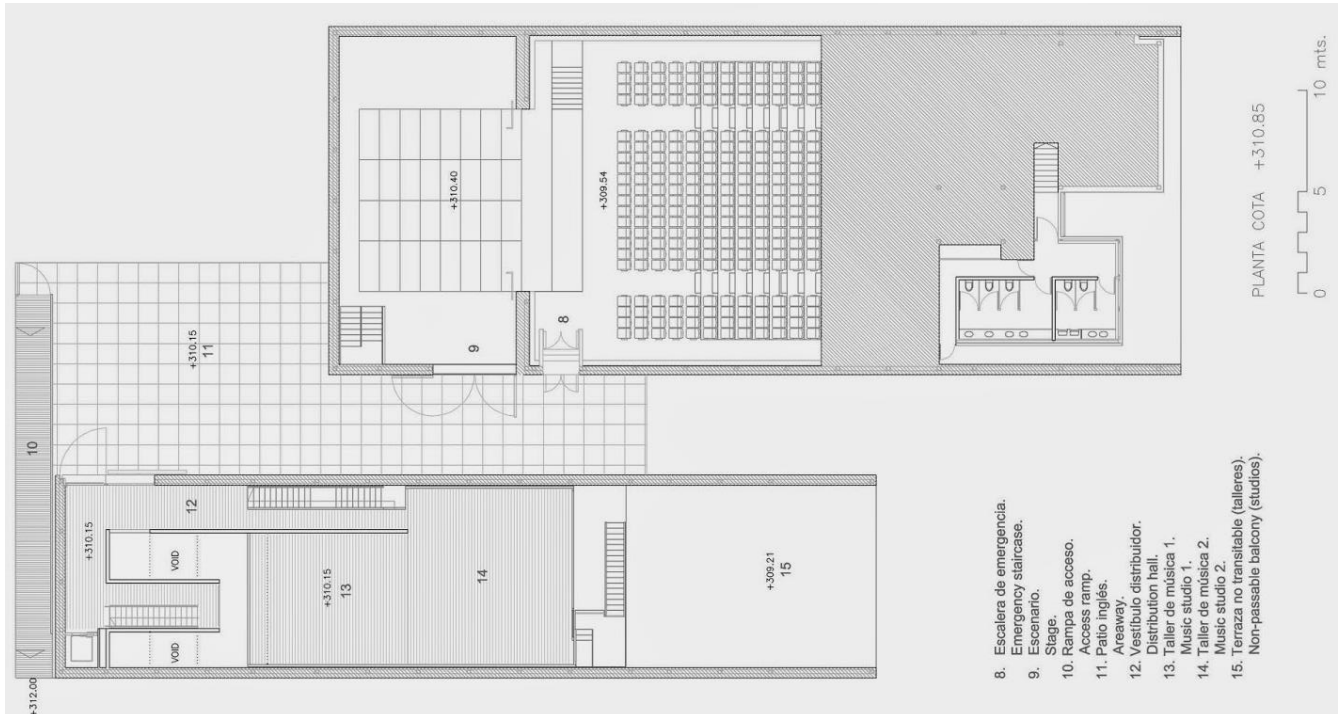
Segunda Planta del Centro de Artes Escénicas de Níjar.
